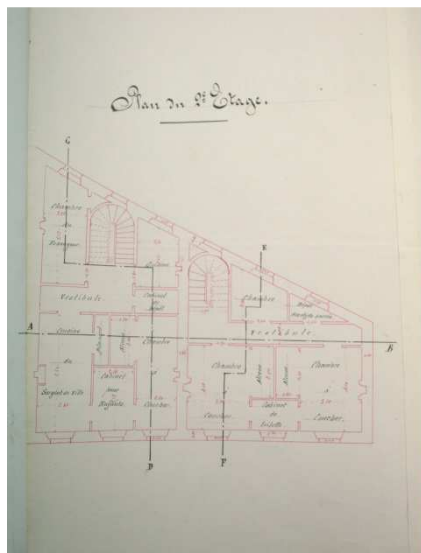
Projet de construction d'un hôtel de ville et d'un presbytère, plan du premier étage.
